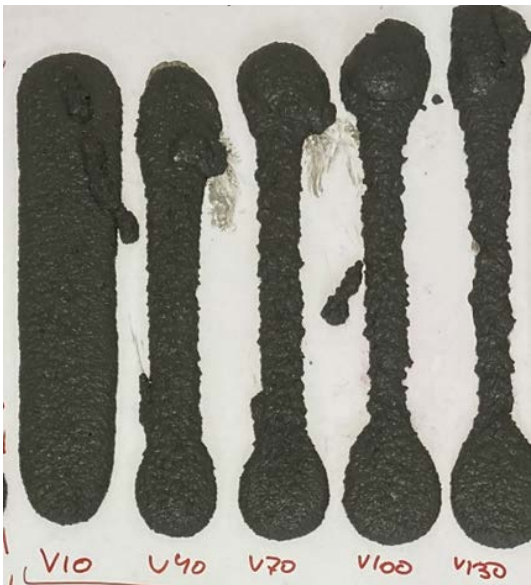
Prueba de impresión con boquilla de 25 mm y altura de capa 15 mm.
